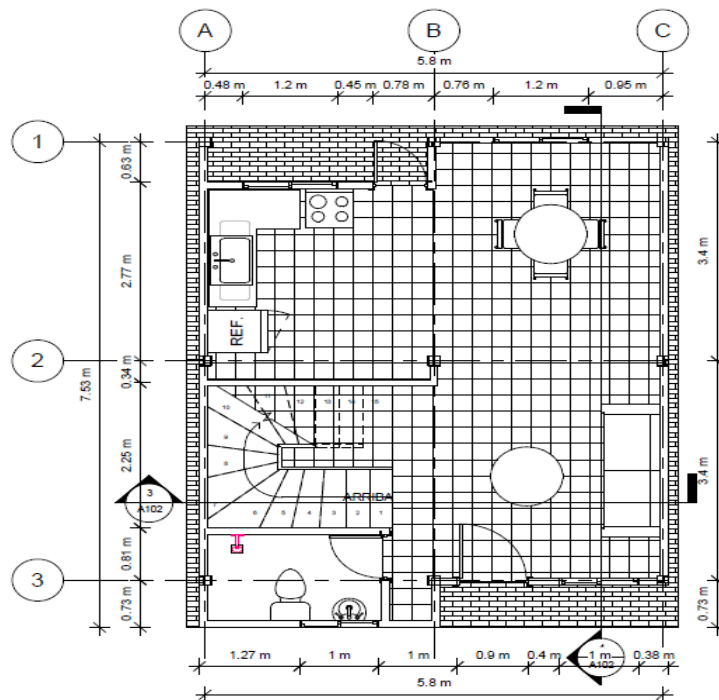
Vista en planta vivienda dos pisos (planta baja)
